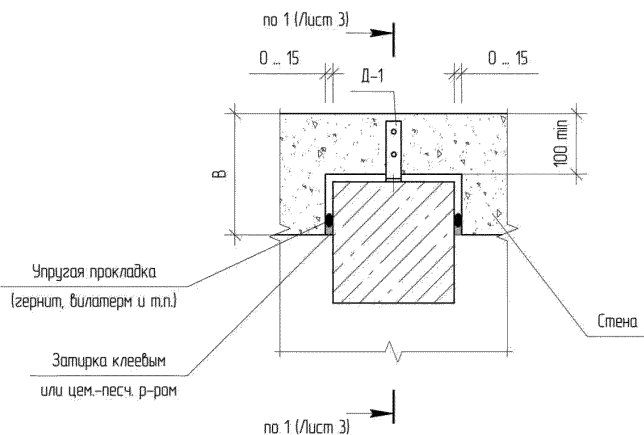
Маркировочная схема узлов связи наружных стен с несущими вертикальными конструкциями
